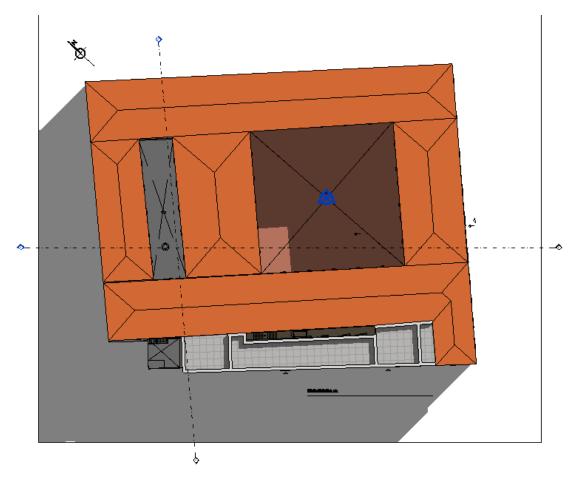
Plano de cubiertas – Fuente: Elaboración Propia
